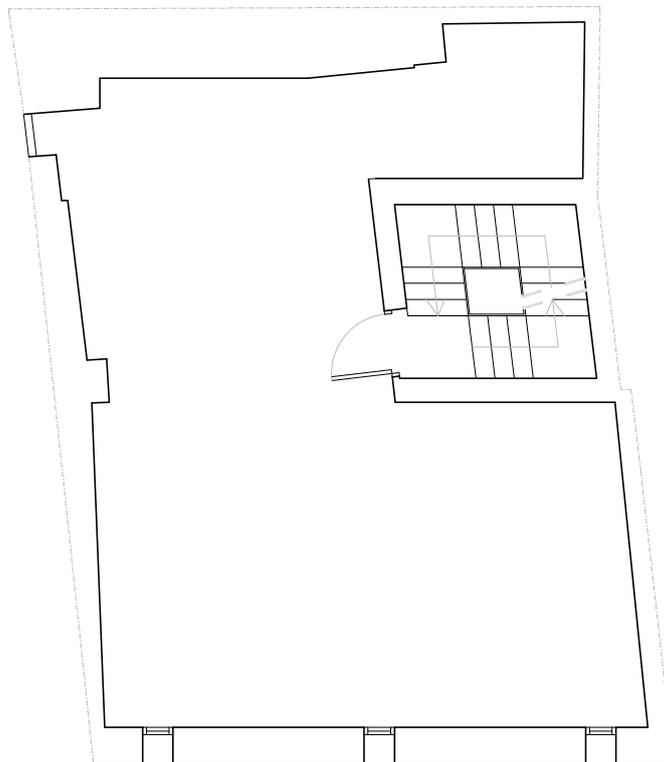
Planta Cuarta / Bajo Cubierta Edificio Actual, Fuente: Elaboración Propia
